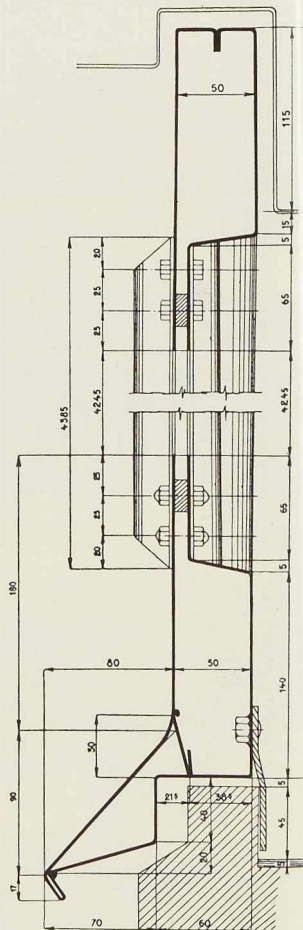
Coupe dans une cloison vitrée fixe, en tôle d'acier.
